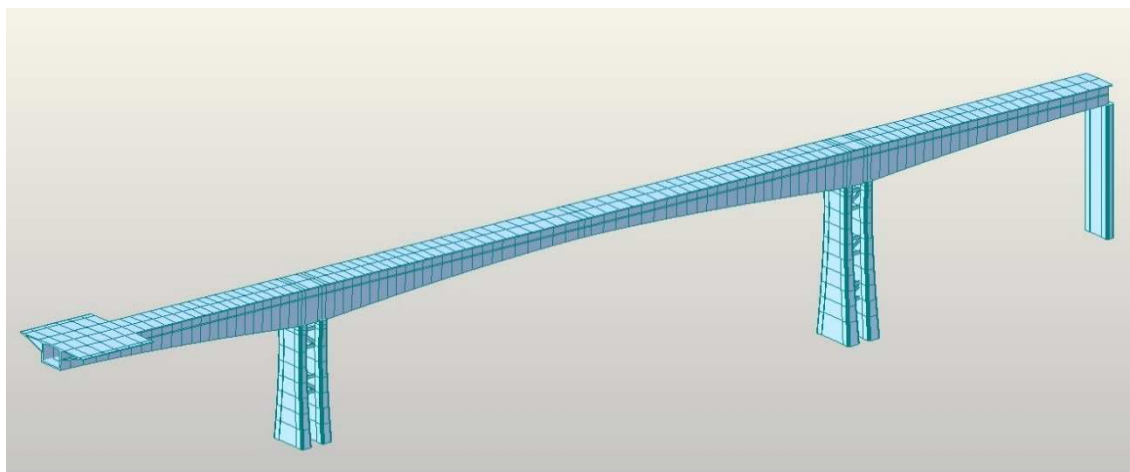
Fáze 13 - vybetonování desáté lamely
